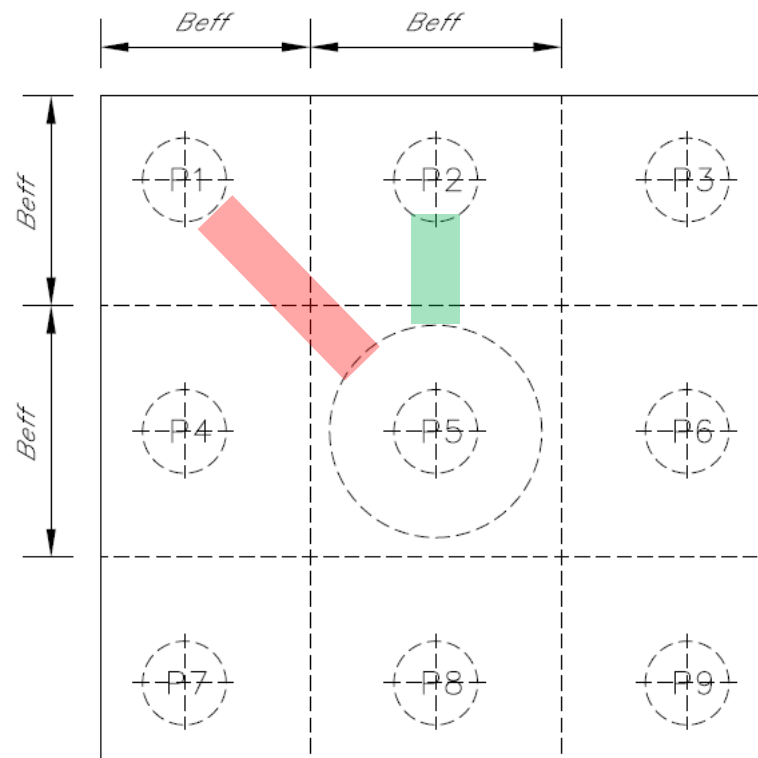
Vista in pianta - Tirante-puntone centrale (verde) e di spigolo (rosso)
